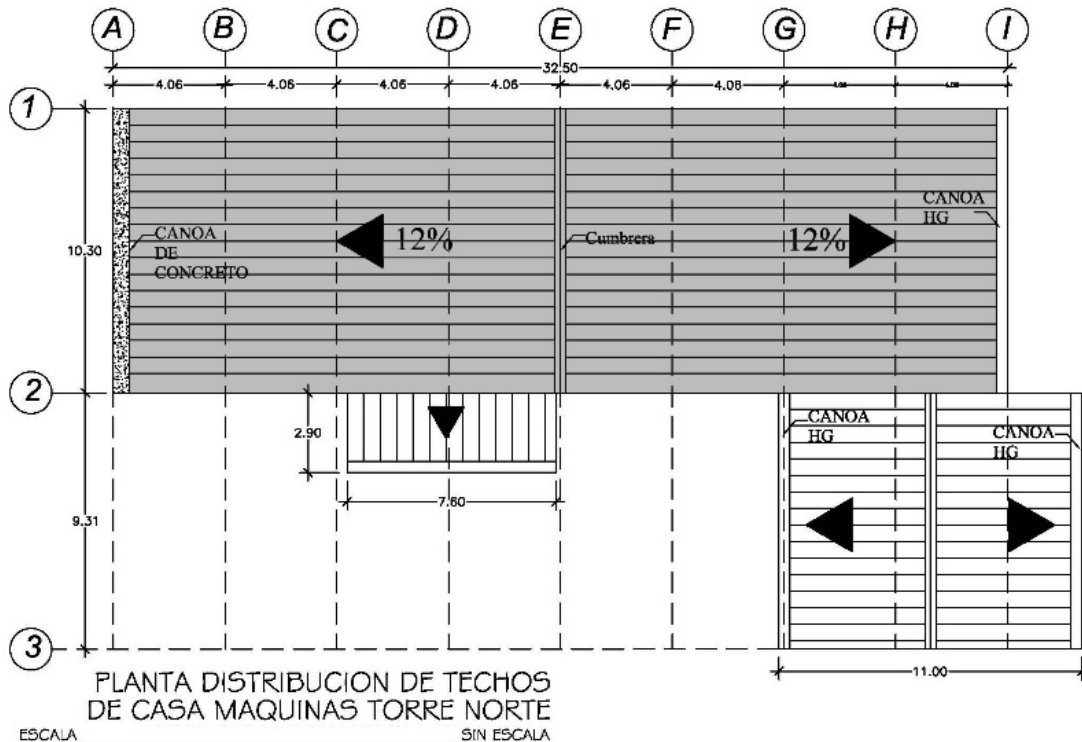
Planta de techos Casa de Máquinas Torre Norte.
